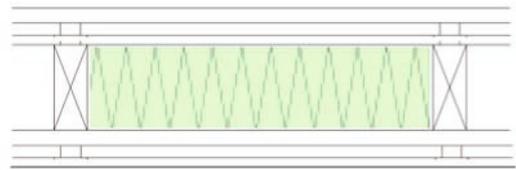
Querschnitt einer zweischaligen Außenwand in Holzbauweise mit Kerndämmung⁵⁵
